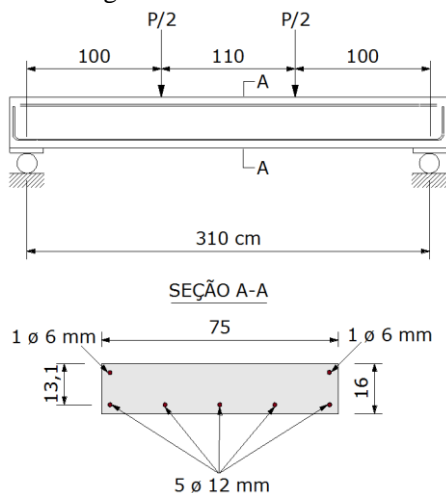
Características das vigas do *benchmark* proposto pelo RILEM.
